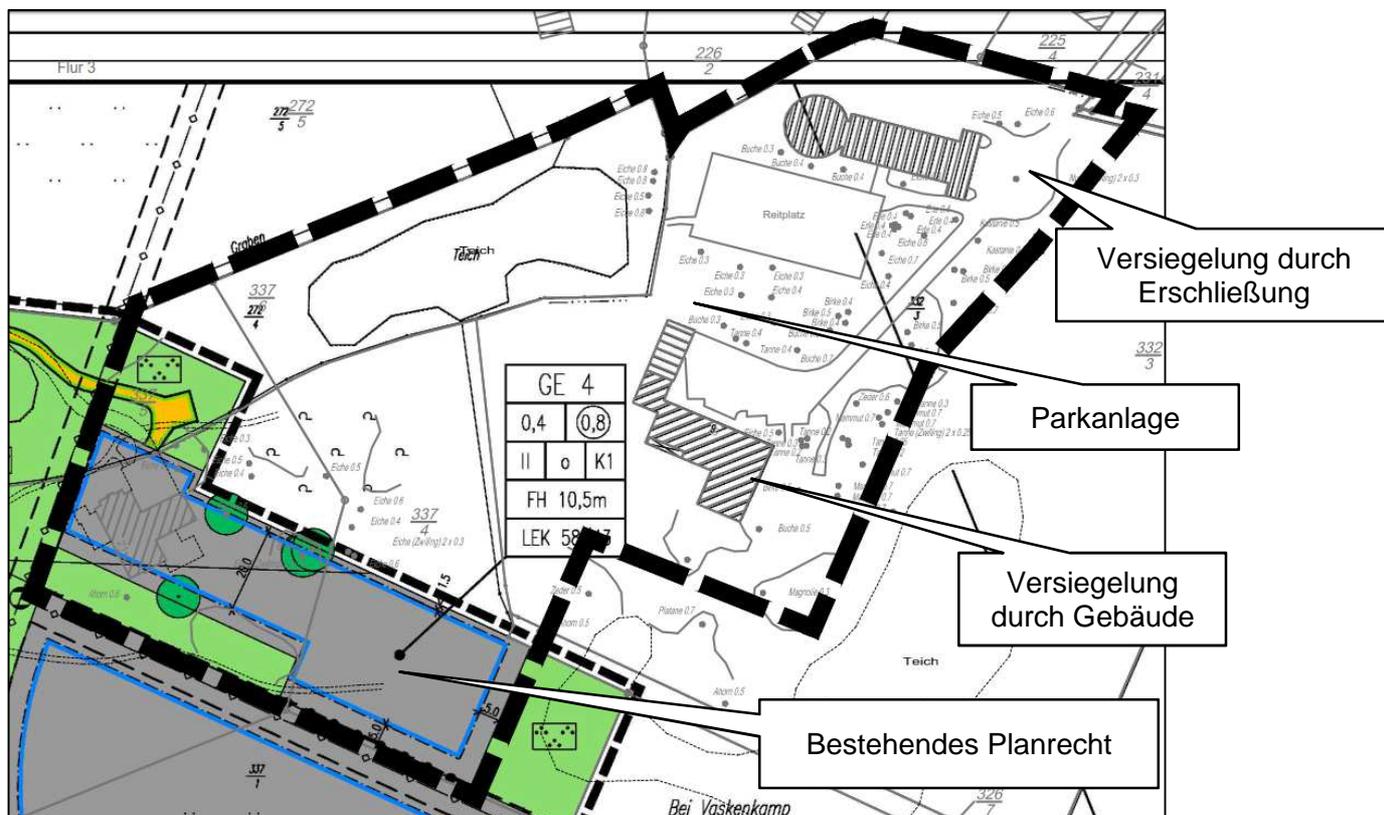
Baumeinmaß, bestehendes Planrecht, Biotopkomplex Parkanlage, Versiegelung
